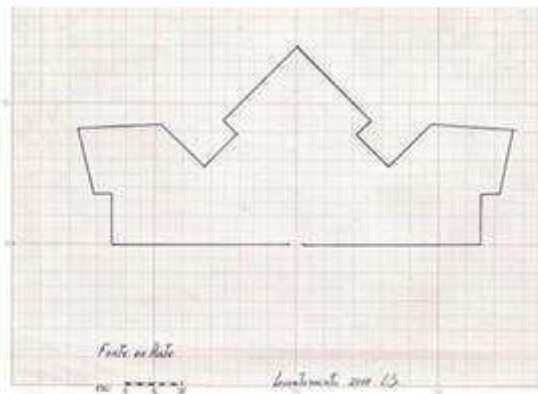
Planta do Forte do Rato, levantamento de 2007.
